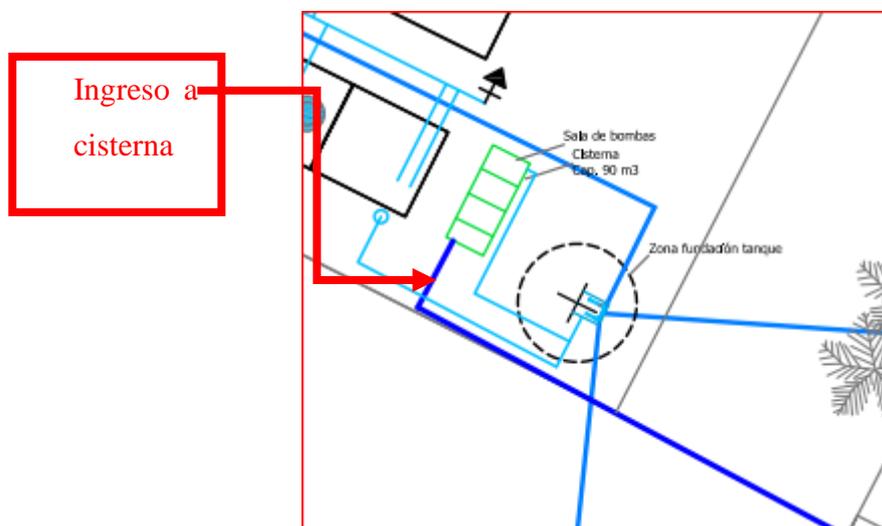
Sector plano red de agua de cisterna y tanque elevado
